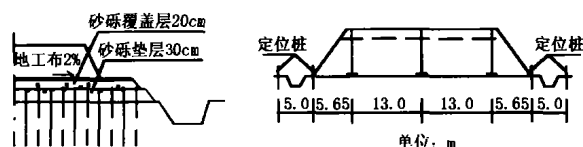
排水板布置剖面示意图 图 4 测点位置示意图
